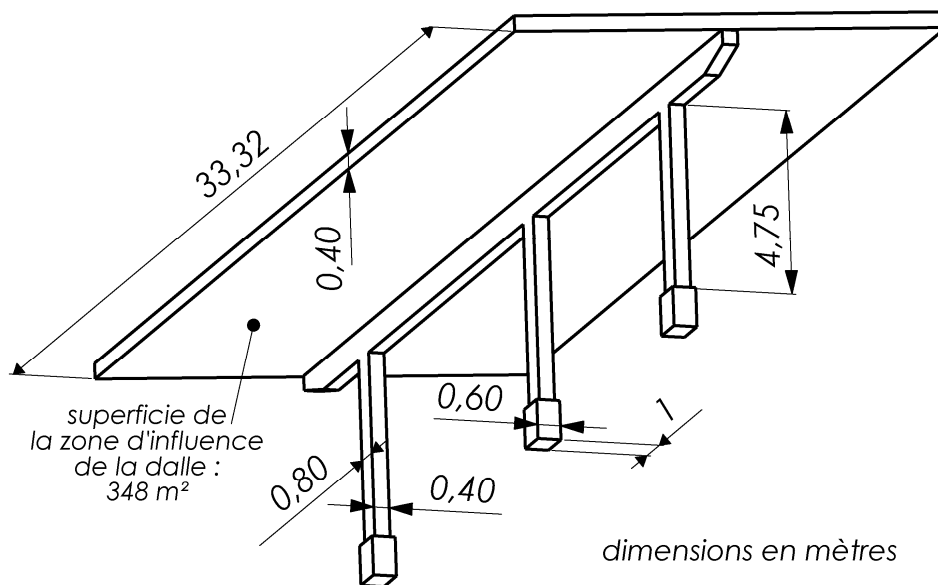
zone d'influence de la dalle sur un ensemble poteaux-poutre
